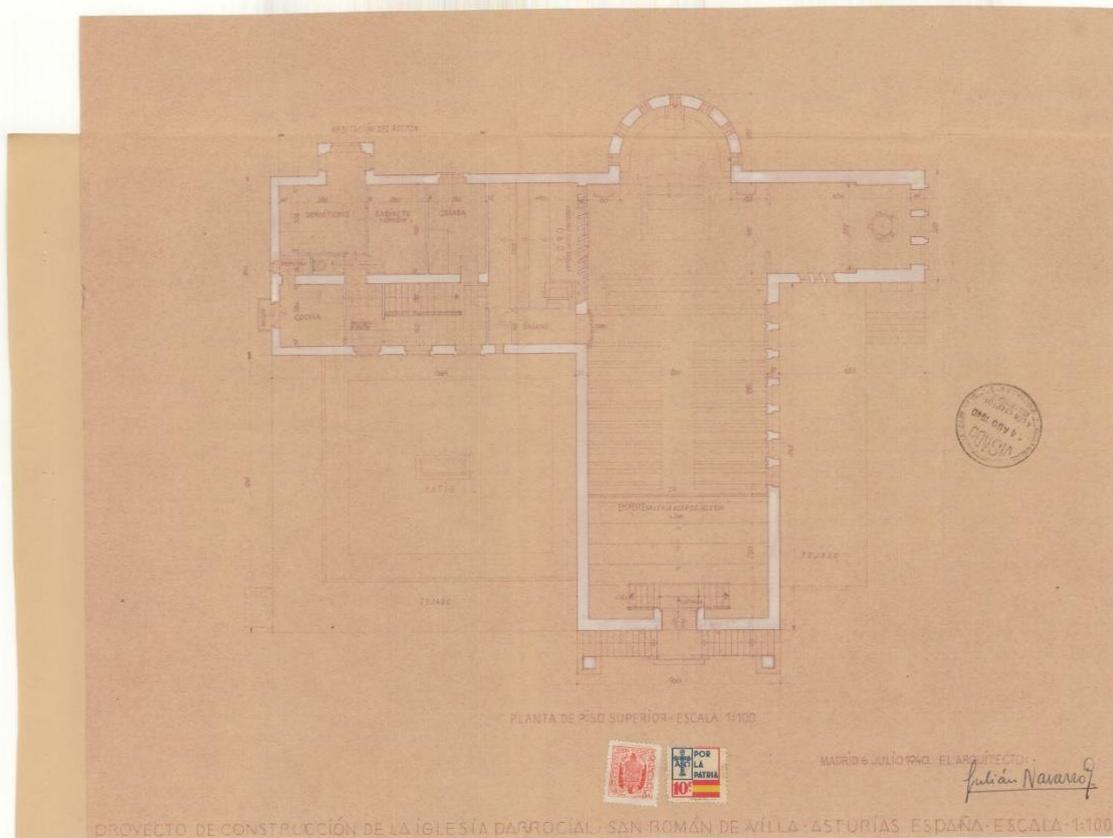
Ntra. Sra. de la Asunción. Planimetría de la planta, 1940
